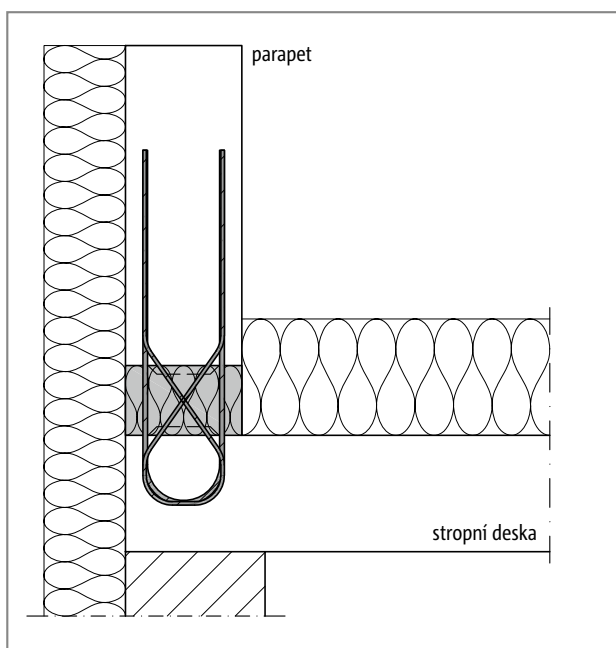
Schöck Isokorb® XT typ AP - vodorovné zabudování: Půdorys, před-sazení parapetu resp. atiky
